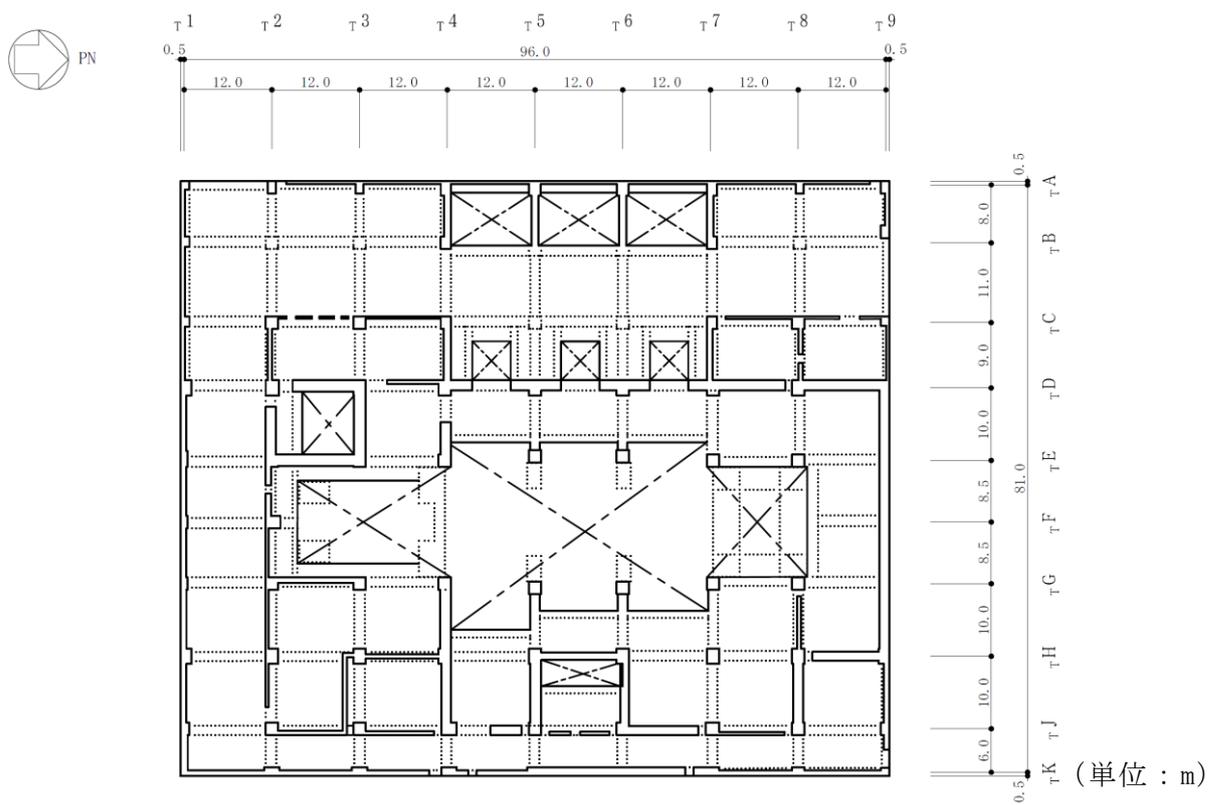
タービン建屋の概略平面図 (1F, T.M.S.L. 12.3m) (3/6)
